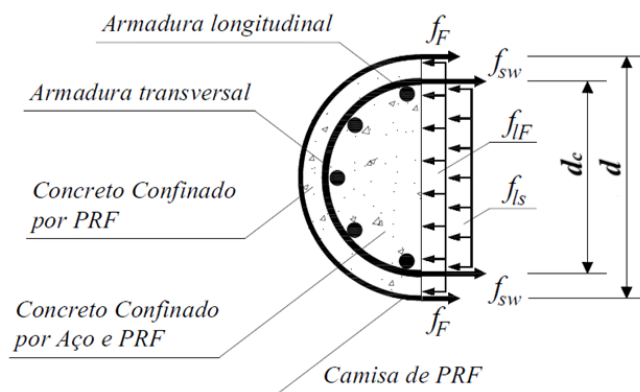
Forças que atuam na seção transversal de concreto armado confinado pelo aço da armadura transversal e *PRF*.
